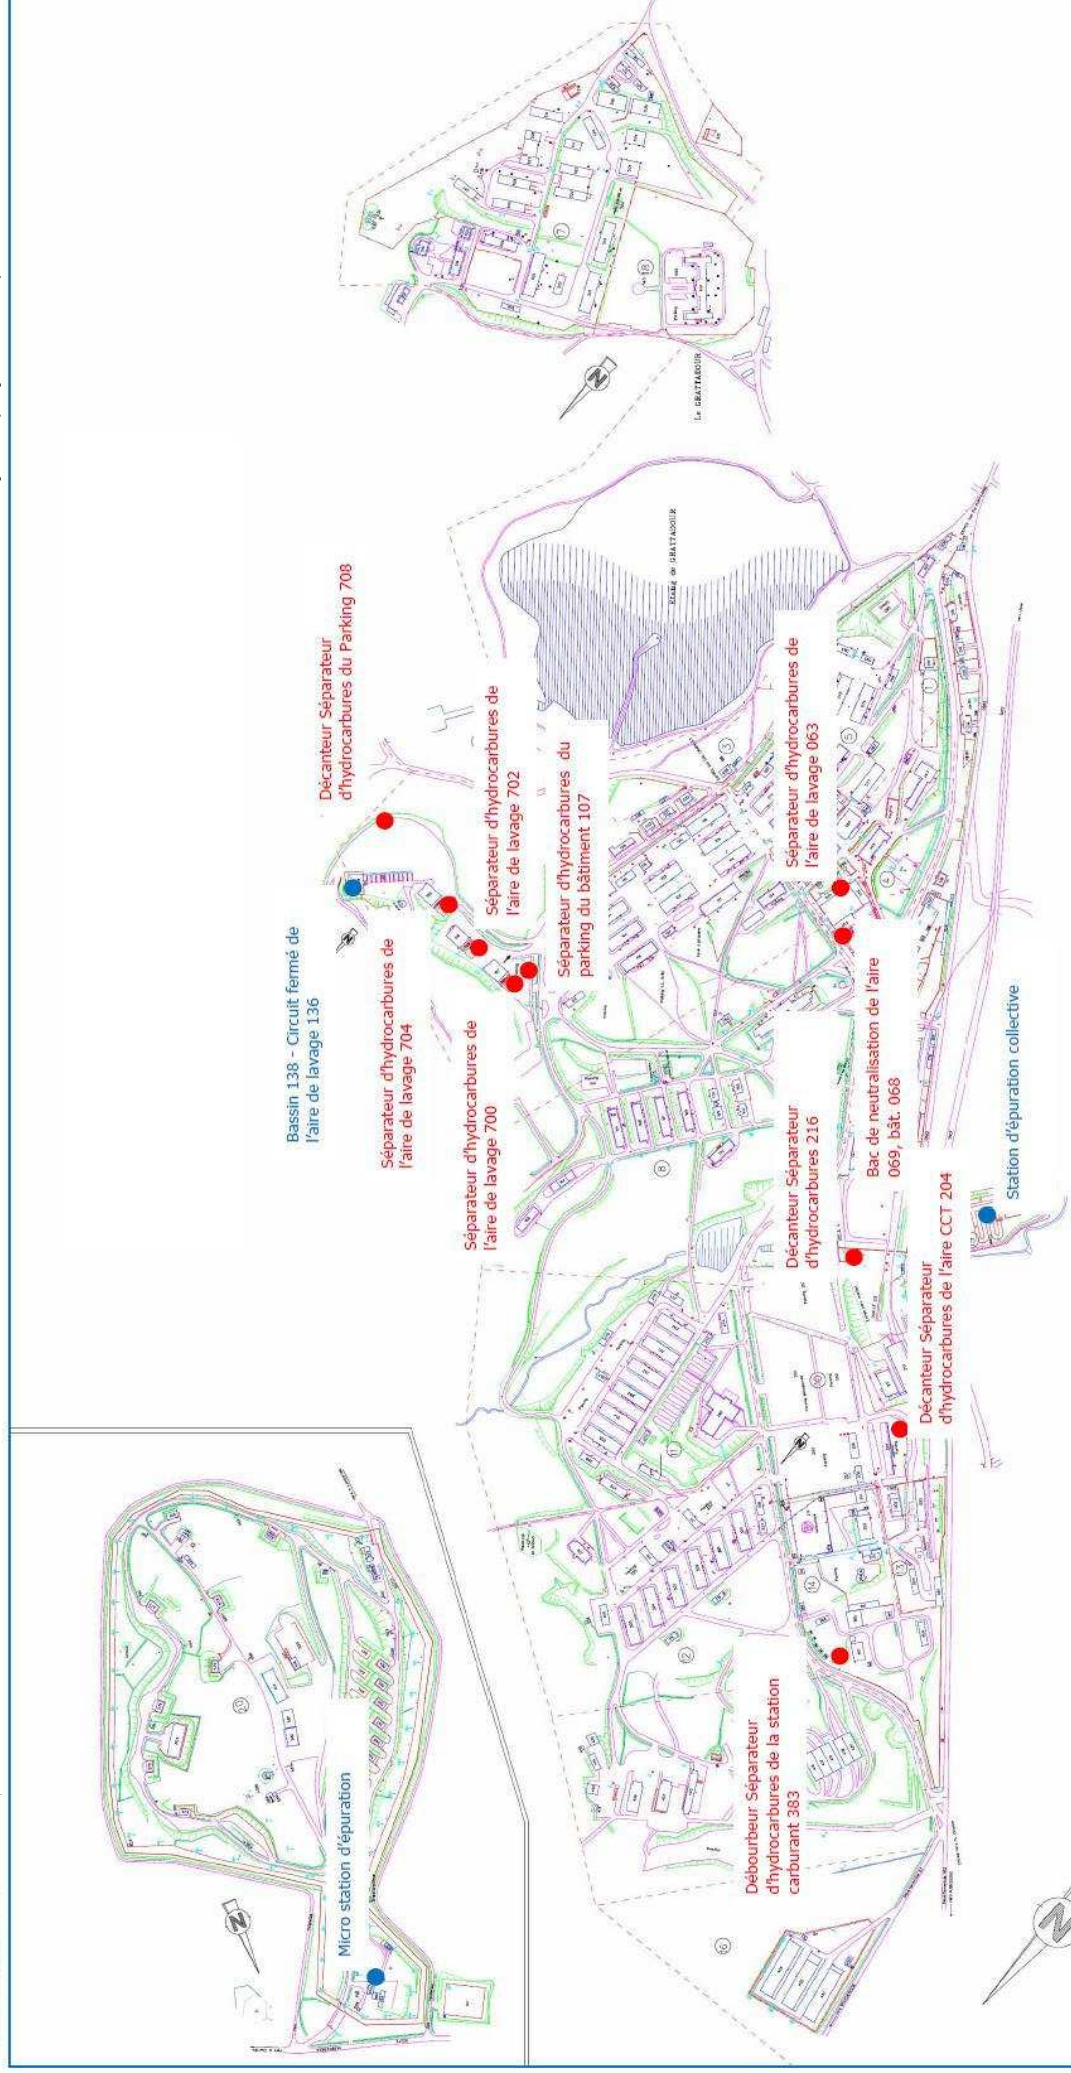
Plan d'implantation des séparateurs d'hydrocarbures (fond de plan : plan bâti transmis par le camp de la Courtine)
